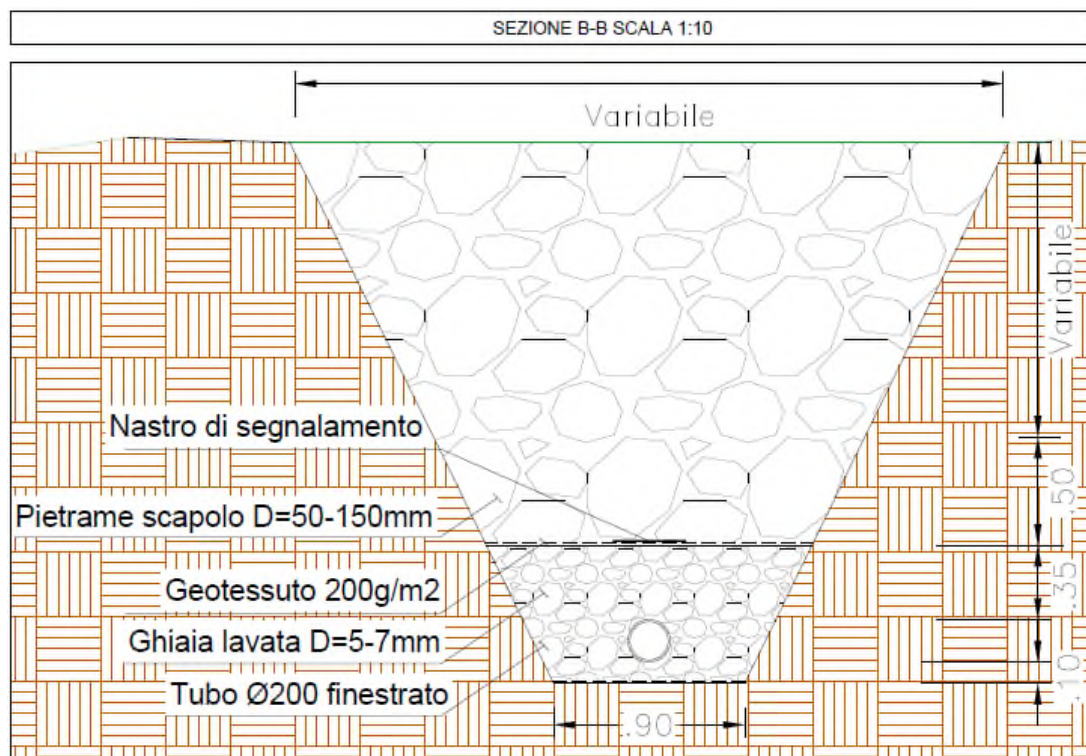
SEZIONE TIPO 1 TRINCEA DRENANTE A TUTTA ALTEZZA (ZONA DI VALLE)
